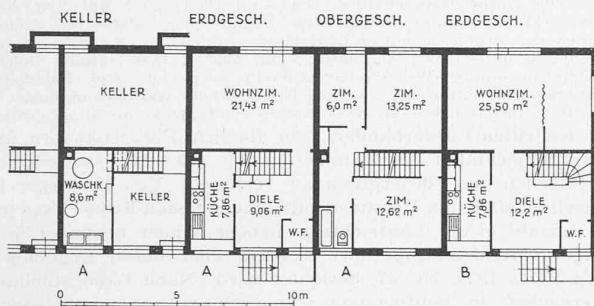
Gruppe D der Baugenossenschaft Theresiengarten. Grundrisse 1:300. A Eingebautes Einfamilienhaus, B Eckbau. Architekt Walter Bosshart, Zürich.
